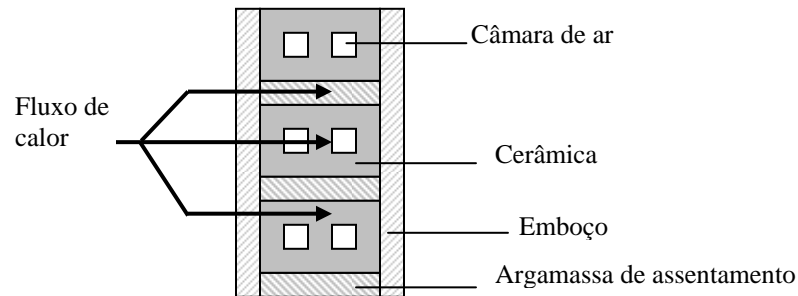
Esquema para componente com camadas transversais e em paralelo.
